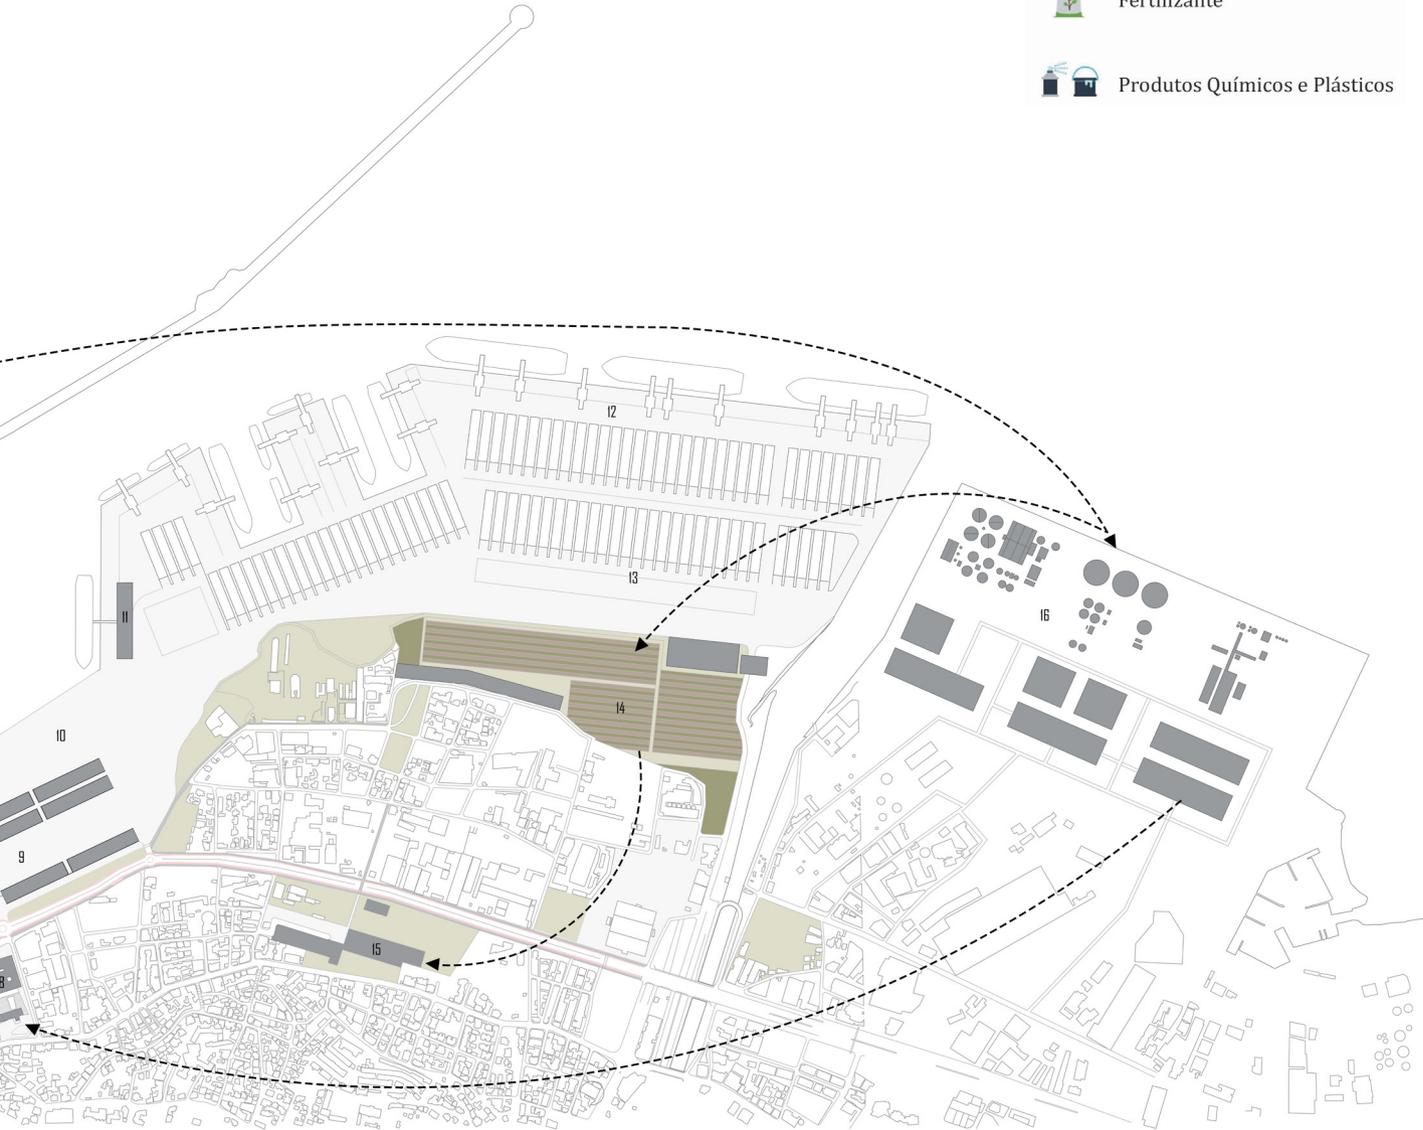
Planta de Implantação. Planta produzida pelo grupo no âmbito de PFA, 2022
